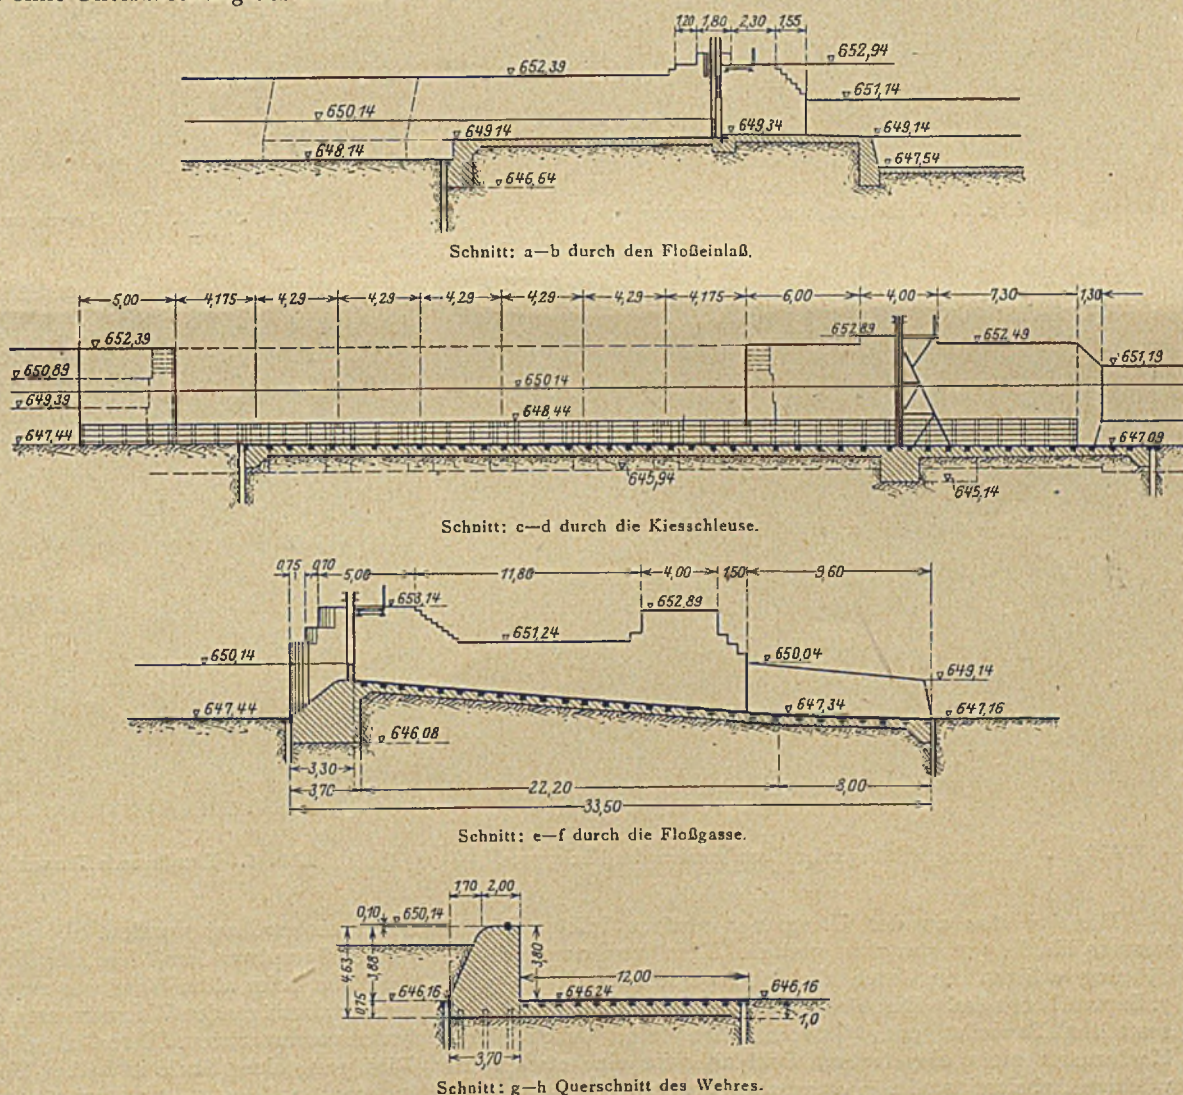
Schnitte durch die Wehranlage vor dem Umbau.
